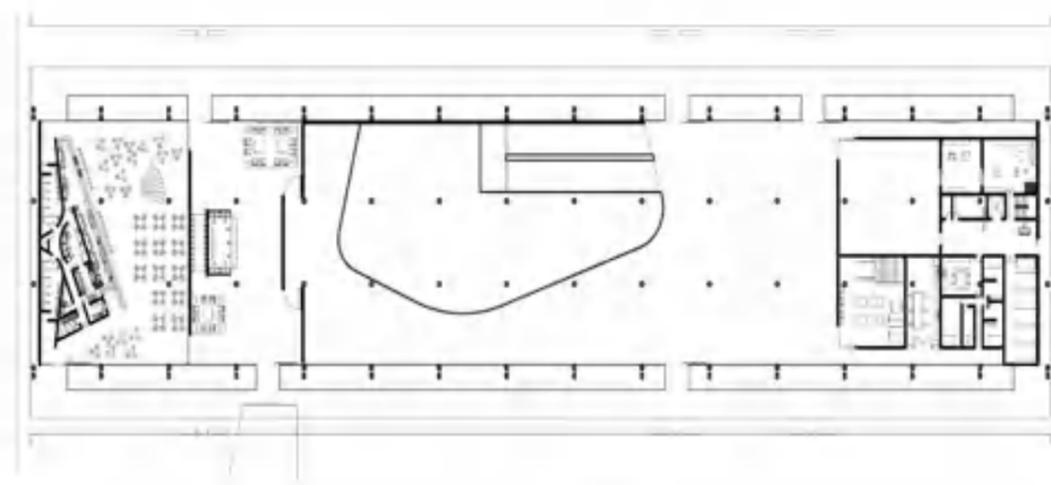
Planta Baixa Pavimento Térreo. Fonte: Brasil Arquitetura.
